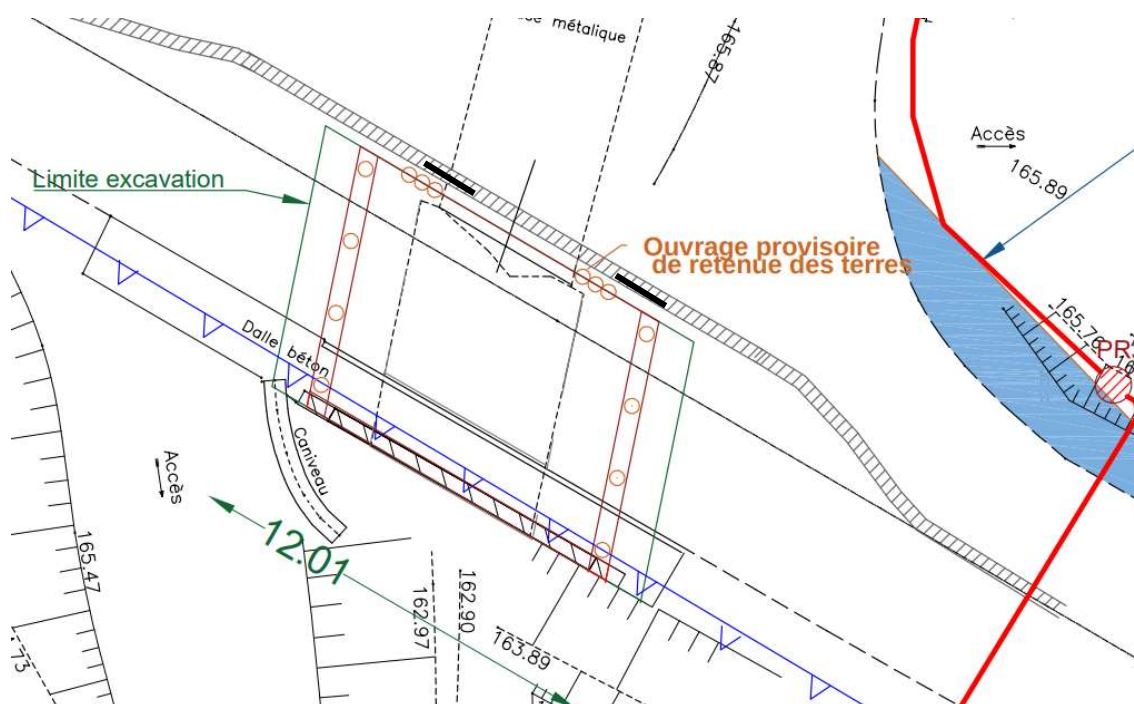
Vue en plan montrant la position de l'ouvrage de soutènement en noir extrait de [10]
